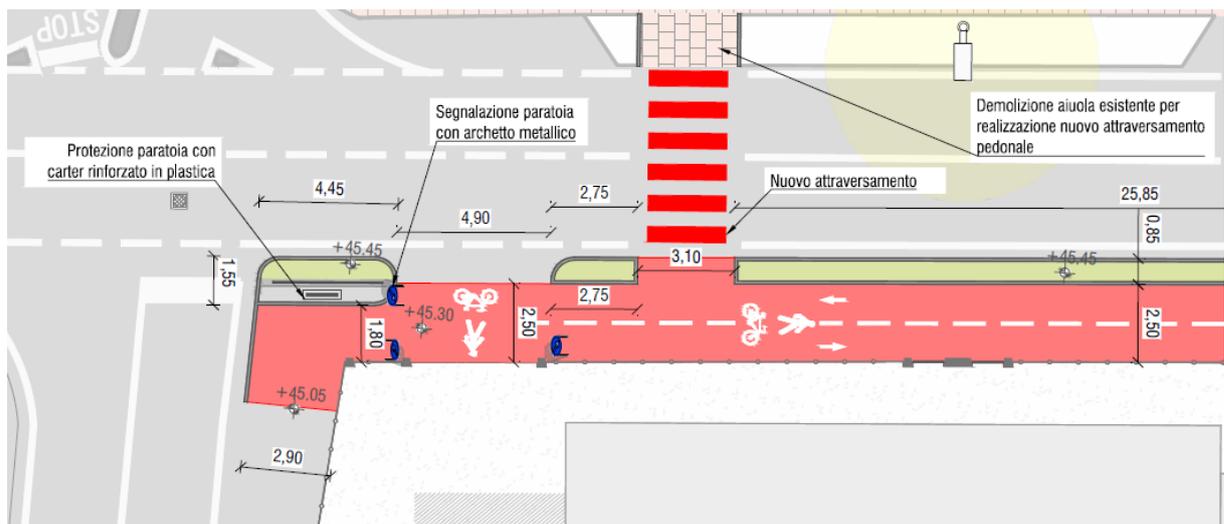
Planimetria di progetto – Primo attraversamento pedonale
